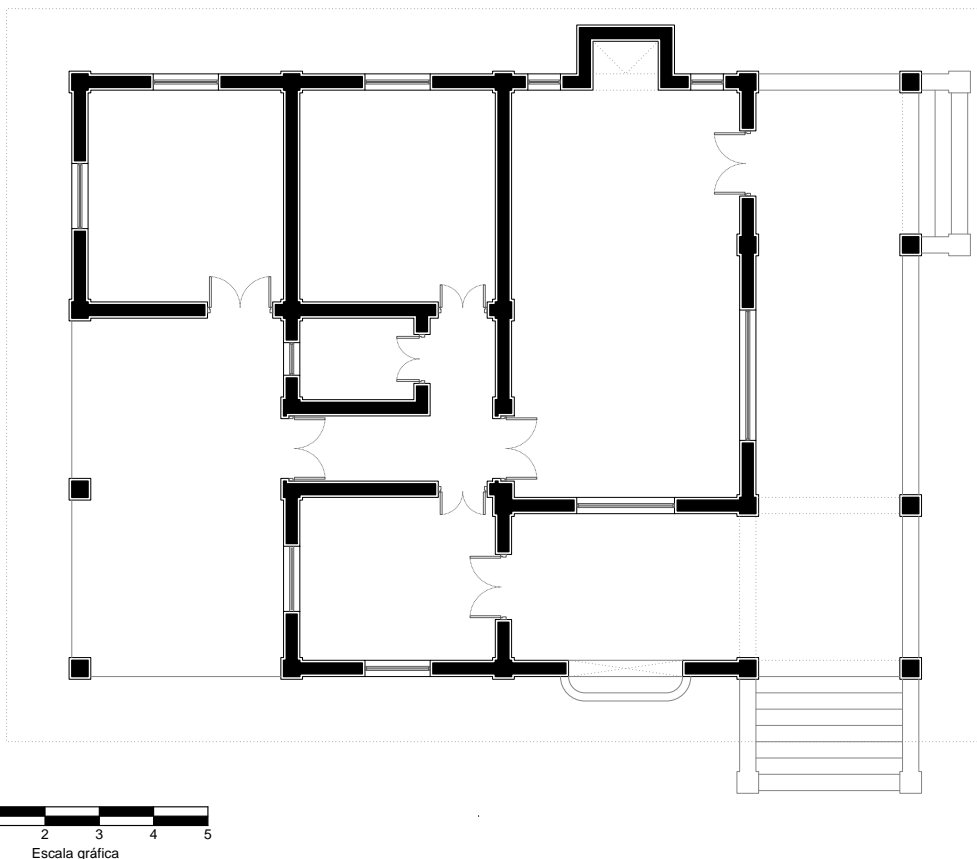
Plano de la casita de piedra en Jiquilpan. Levantamiento y dibujo del autor (2016).
